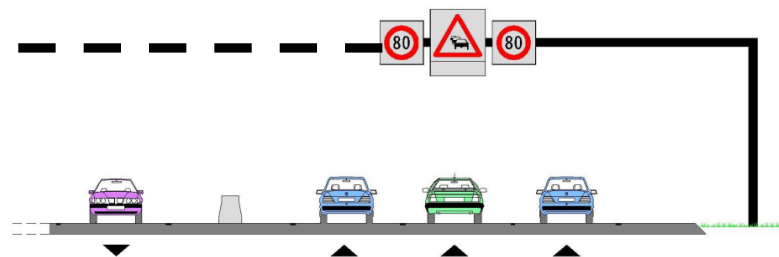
Disposition des HV-AD au-dessus d'une chaussée à 3 voies.
